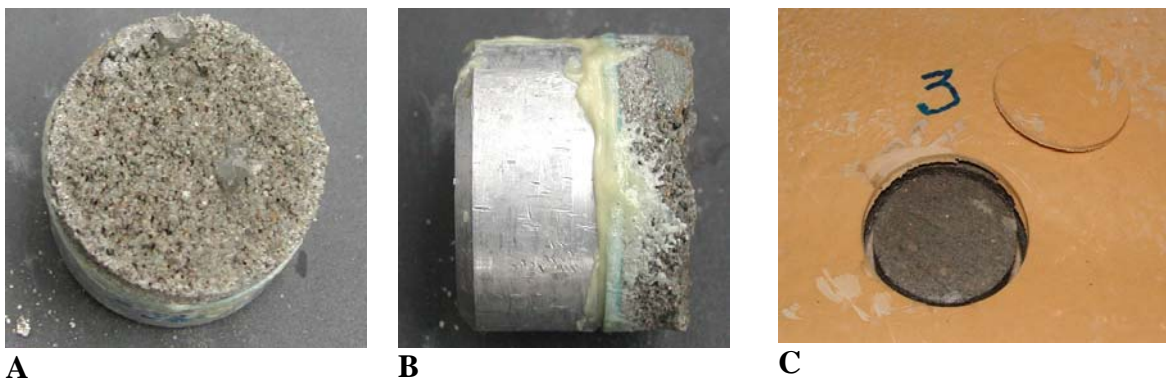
Haftzugprüfungen an den Polyurethanbeschichtungen. A: Vollständiges Versagen des Betonuntergrundes, Frontalansicht des Probekörpers. B: Vollständiges Versagen des Betonuntergrundes, Seitenansicht des Probekörpers. C: Kein Verbund zum Betonuntergrund bei einer Polyurethanbeschichtung.
